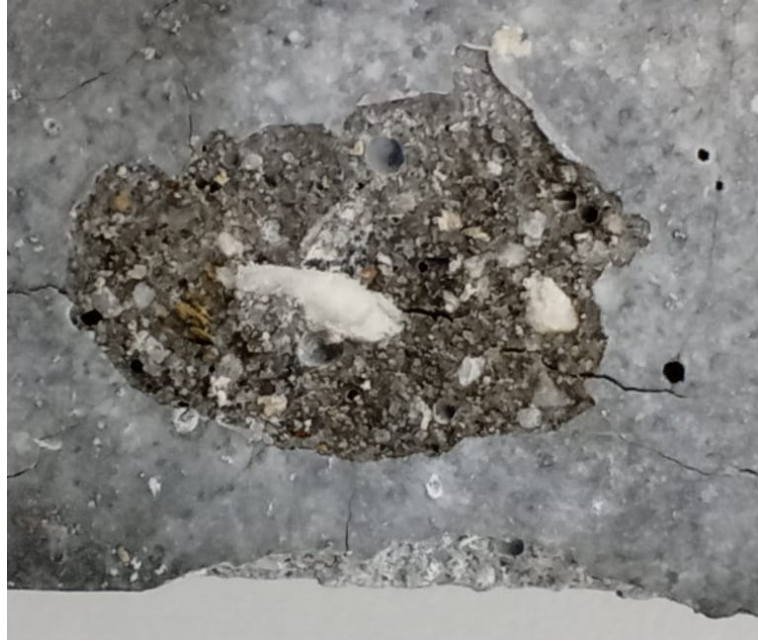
trincas radiais em torno de material branco em área lascada em barra de argamassa traço AAA 10 RVM
